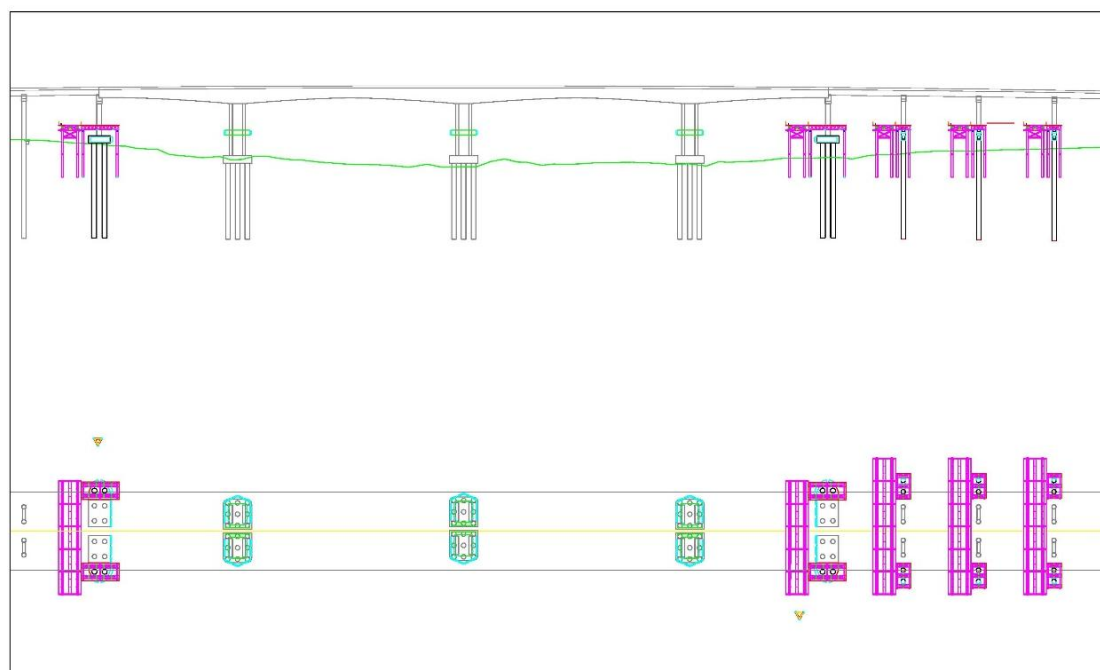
鸡啼门大桥防撞设施施工平台总体方案布置图
